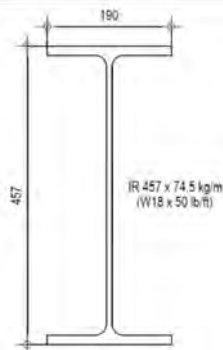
Sección transversal de vigas secundarias. Fuente: Elaboración propia.
